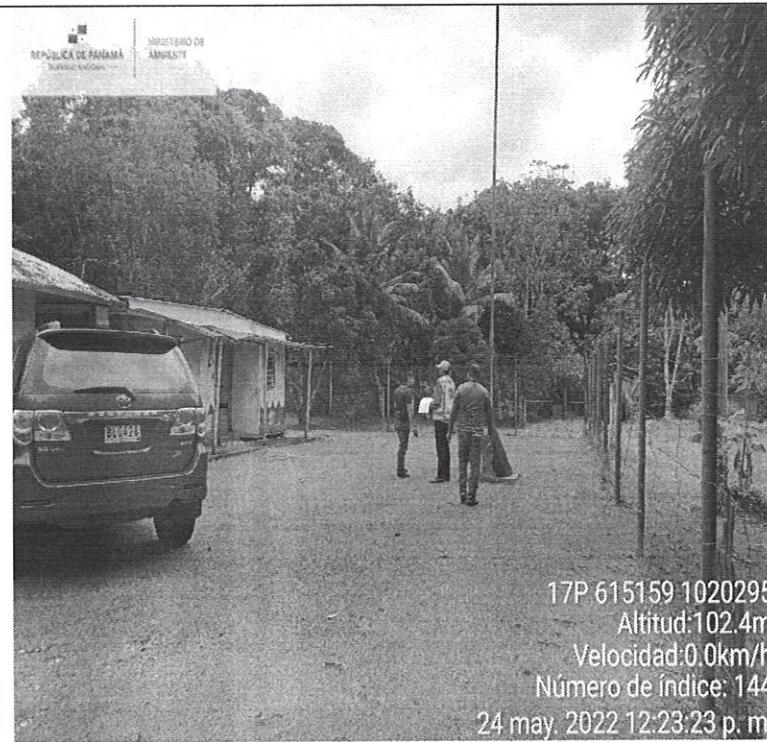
Área donde se construirá las infraestructuras del Puesto de Control de Piña
